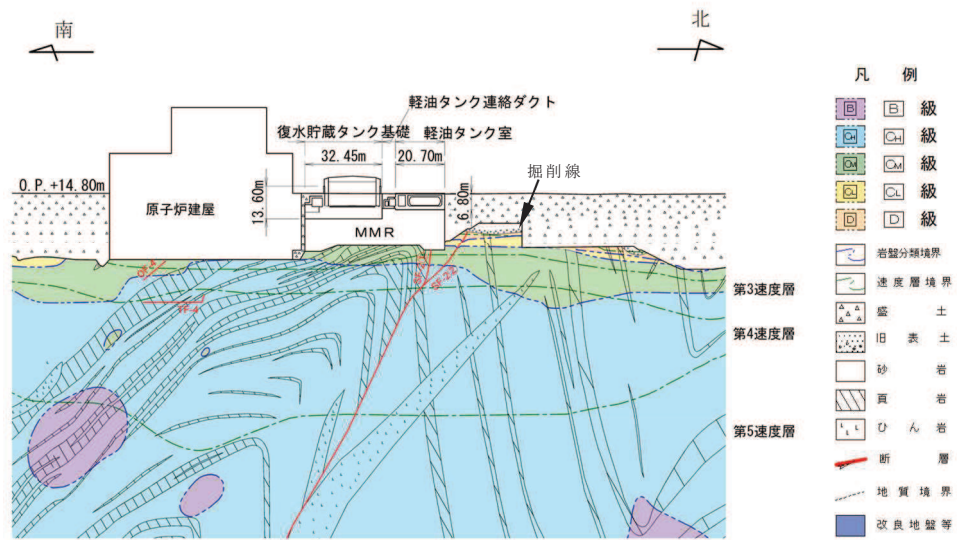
軽油タンク室，復水貯蔵タンク基礎の地質断面図 (⑮-⑮断面)
